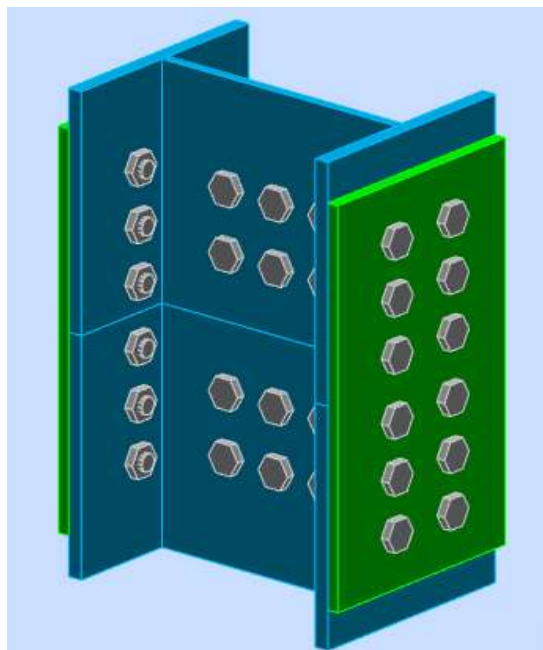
« Vue d'assemblage poteau-poteau fait par Robot »
